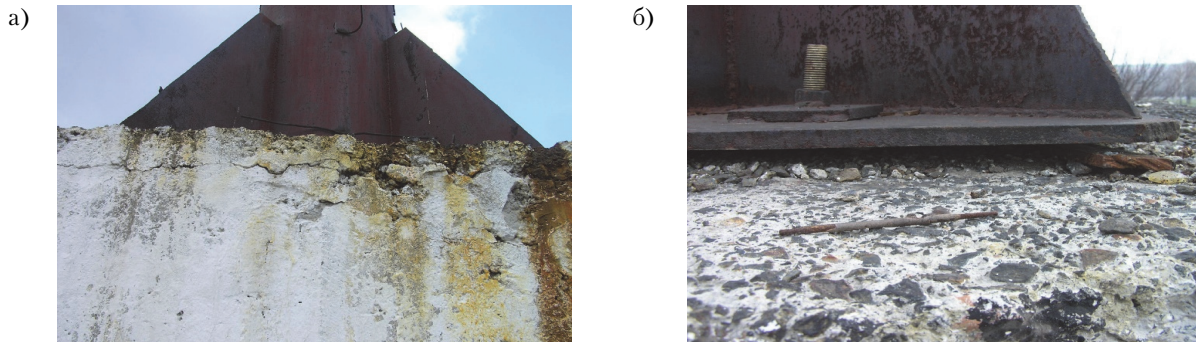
Дефекты и повреждения элементов фундамента дымовых труб: а) сколы бетона в зоне анкерных креплений опорной пластины коррозия арматурной сетки; б) коррозия опорной пластины, сварных соединений, анкерных креплений до 0,5 мм, зазоры между опорной пластиной и фундаментом до 35 мм.
